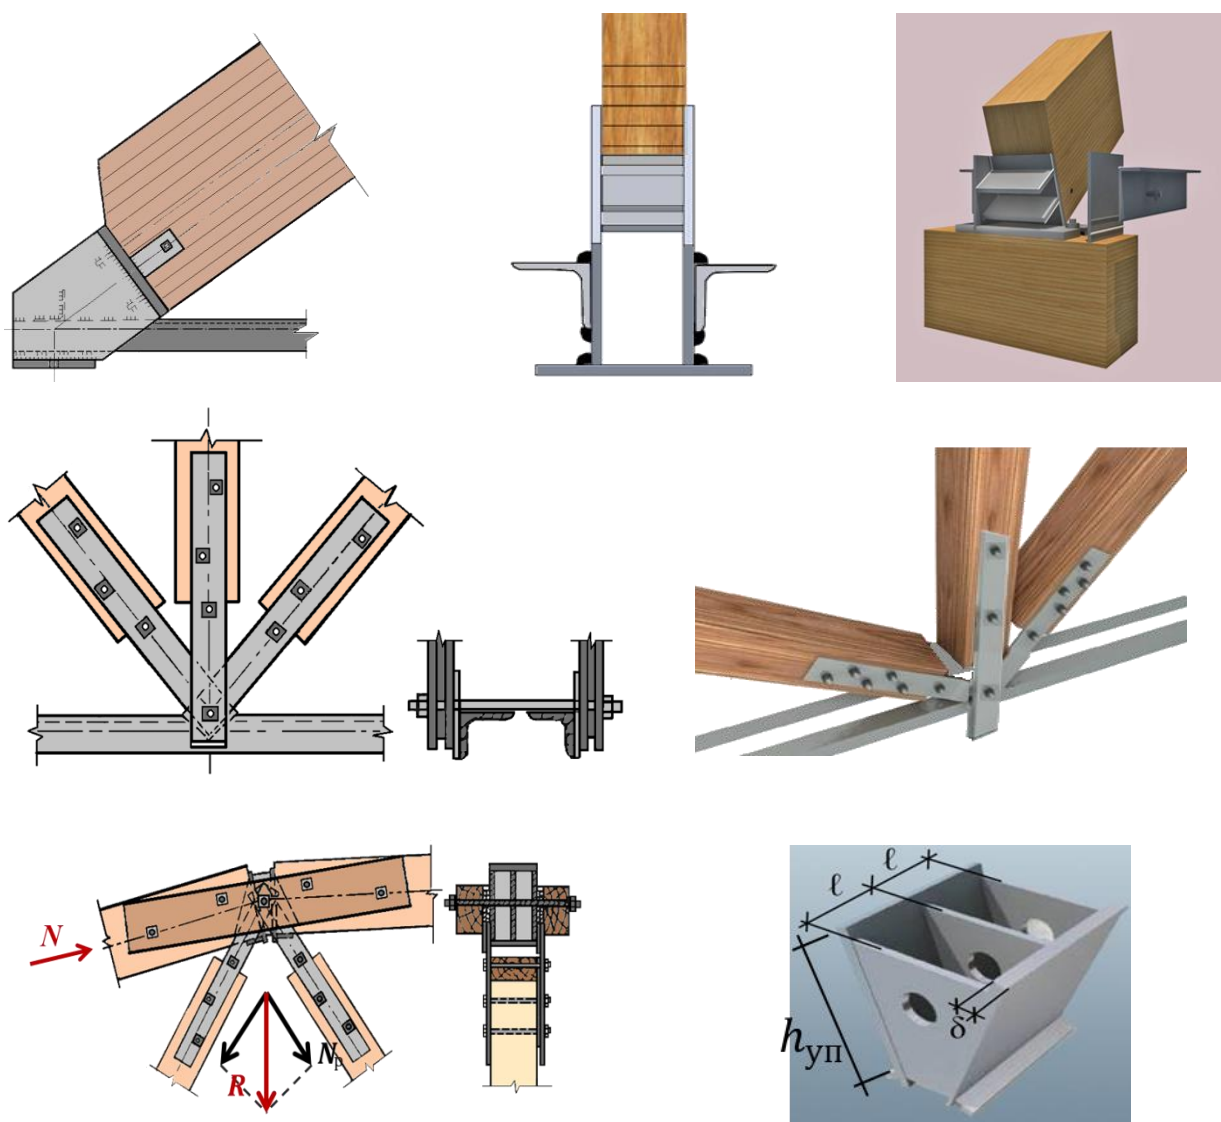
Узлы многоугольной брусчатой фермы системы ЦНИИСК
